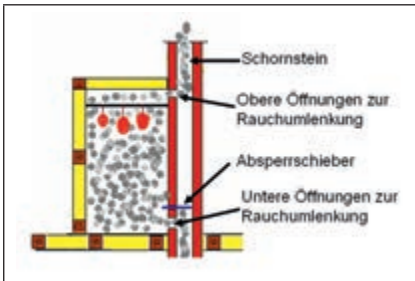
/1: Aufbau und Funktion einer Räucherkammer auf dem Dachboden. (Grafik: Wendel)
